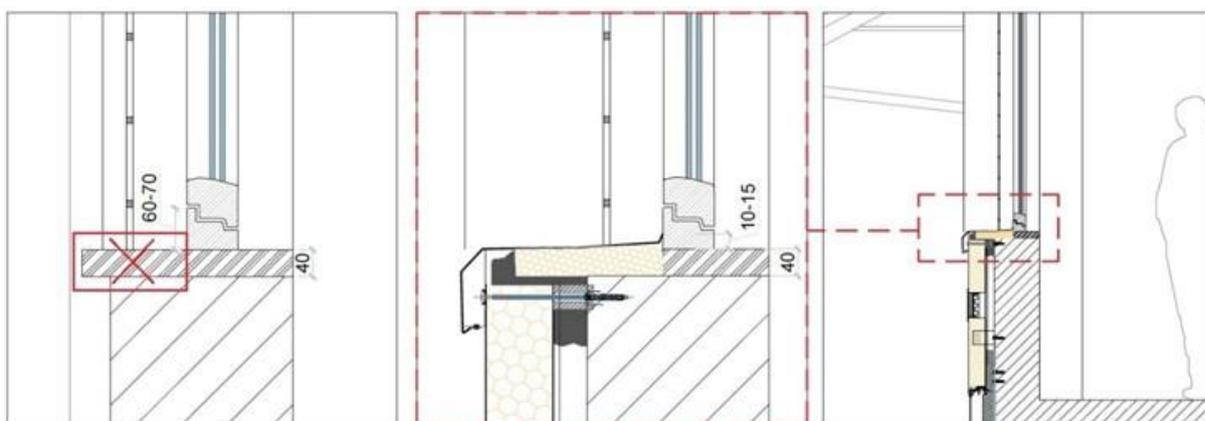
Sezione di dettaglio verticale della finestra – Stato di Fatto e di Progetto
